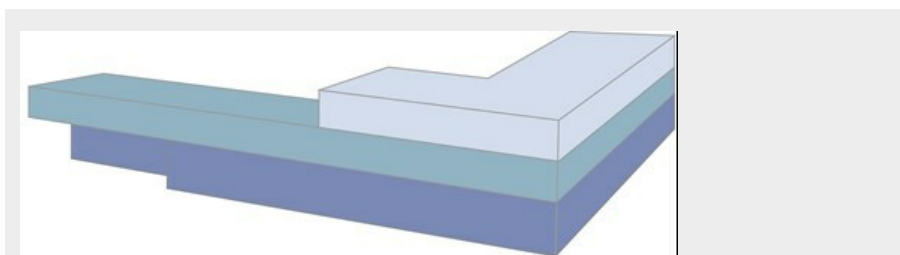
Et eksempel på hvor ca. 1/4 af stueetagens facade er trukket tilbage.
